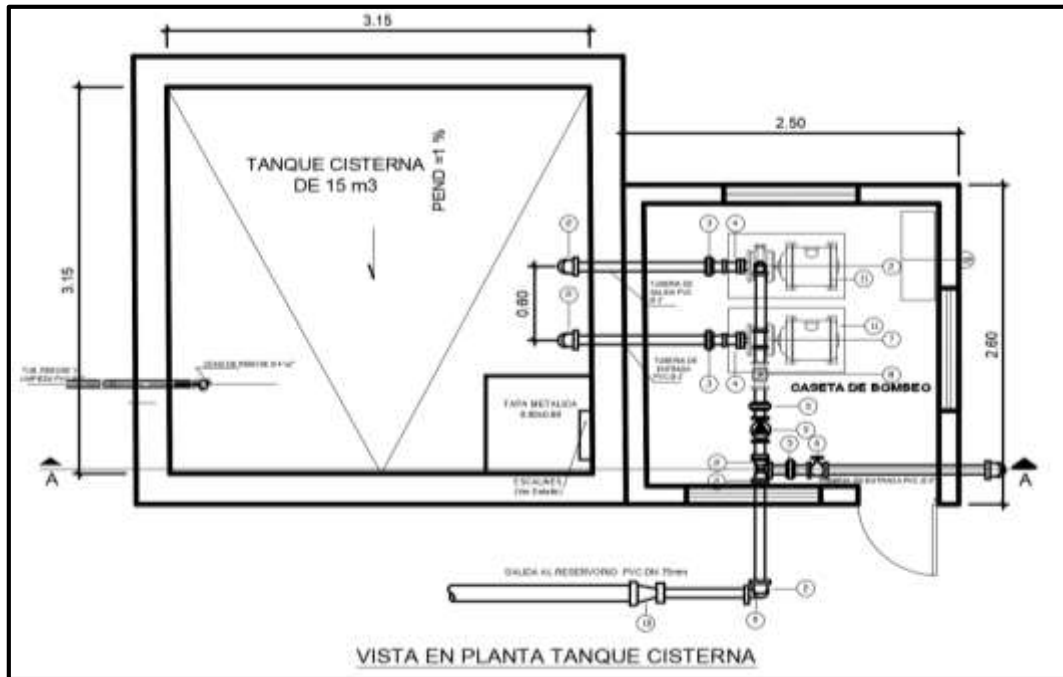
Plano de planta del tanque cisterna de 15 m<sup>3</sup>
